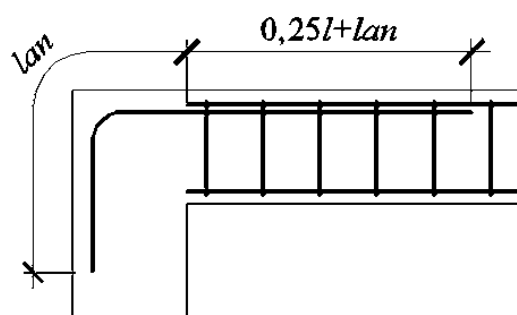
Армуння опорних вузлів головних балок:
